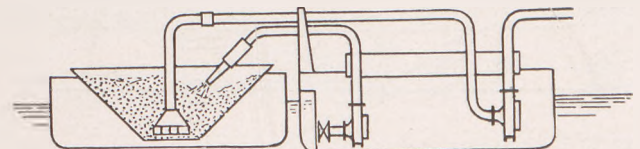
Saugbagger zum Saugen aus Schuten und zum Wegspülen des Gemisches.
